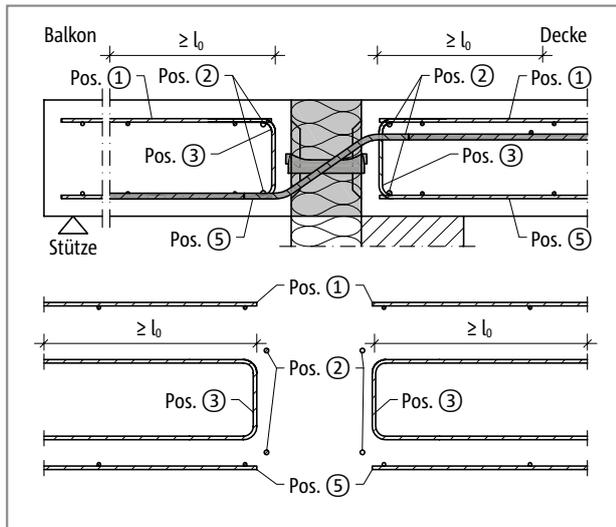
Schöck Isokorb® Typ QXT60 bis QXT90: Bauseitige Bewehrung
